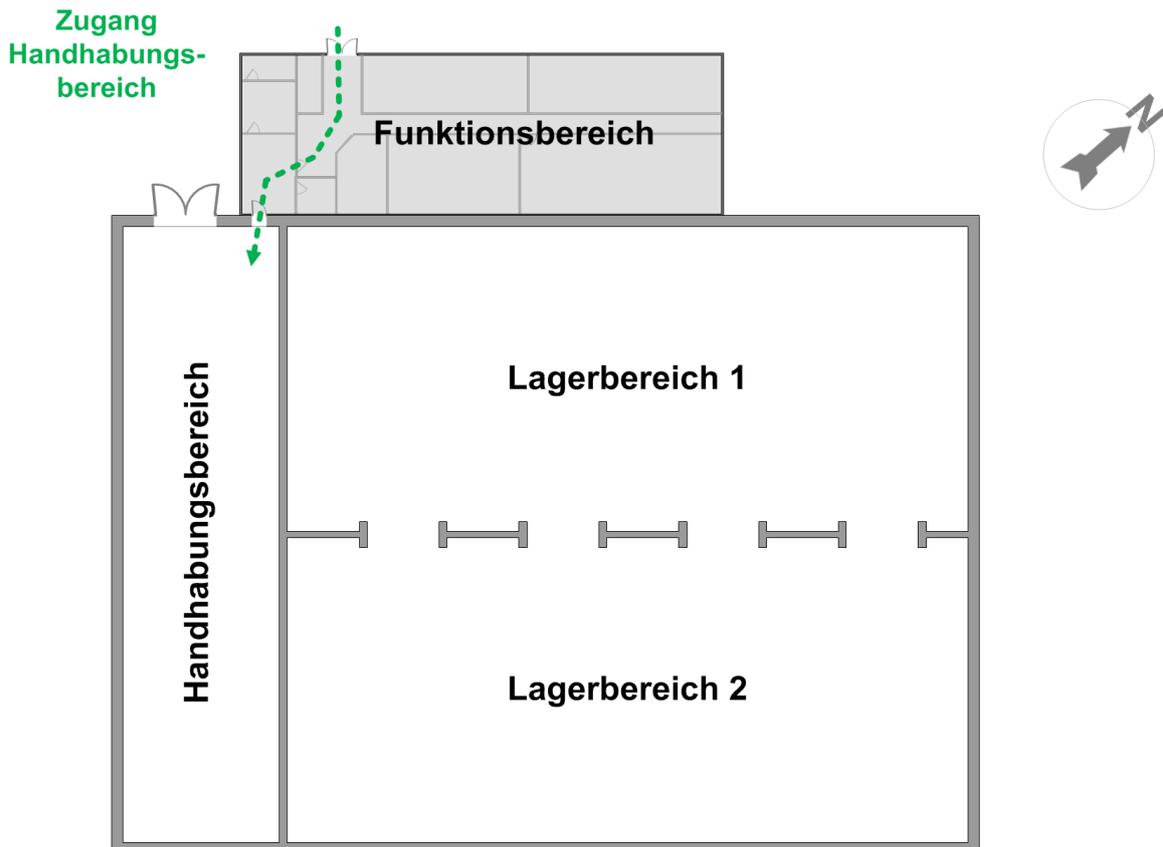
Schematischer Grundriss des LasmAaZ
